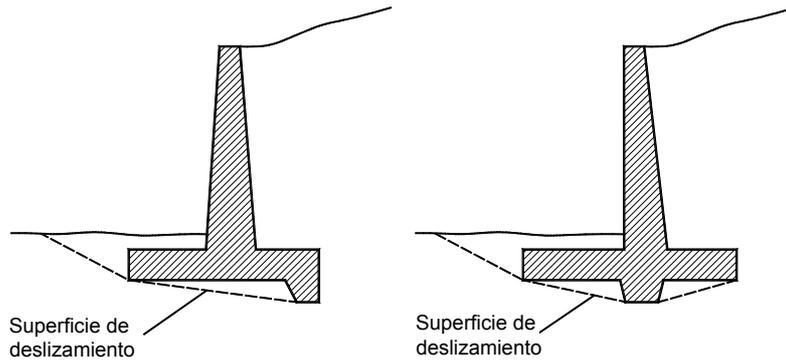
Posibles superficies de deslizamiento en muro con zarpa
